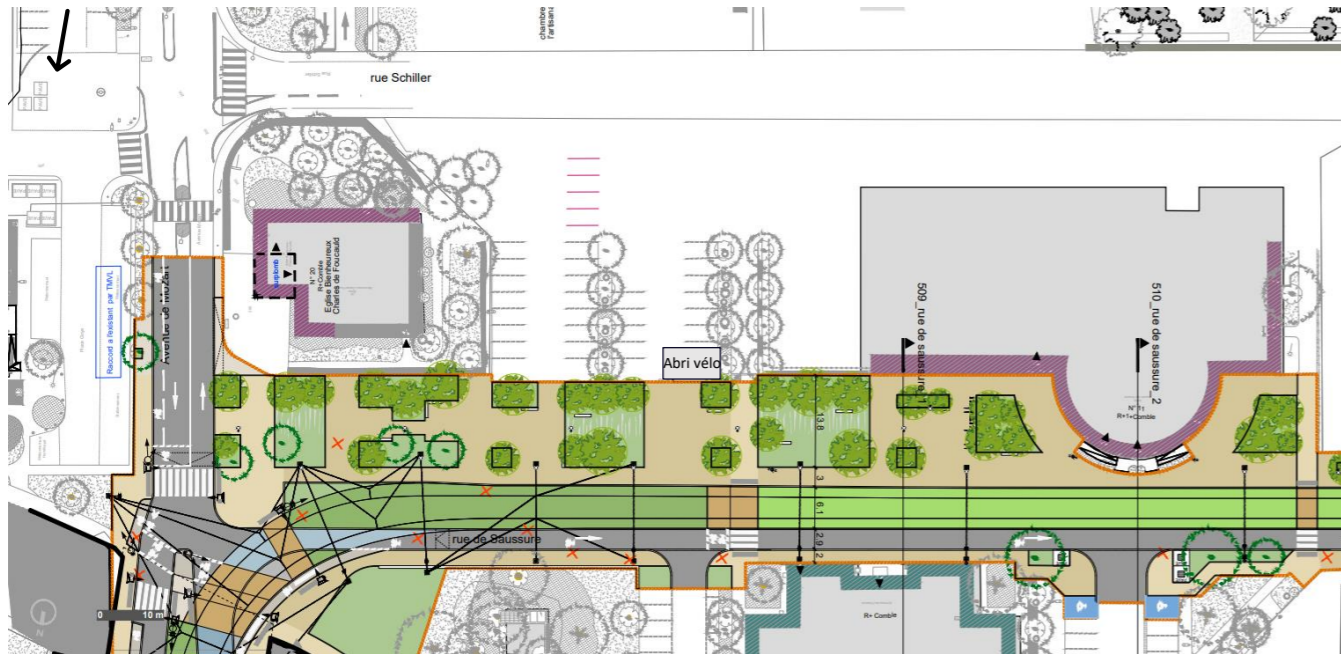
PLAN D'AMENAGEMENT DE LA PLACE MAIRIE ANNEXE
